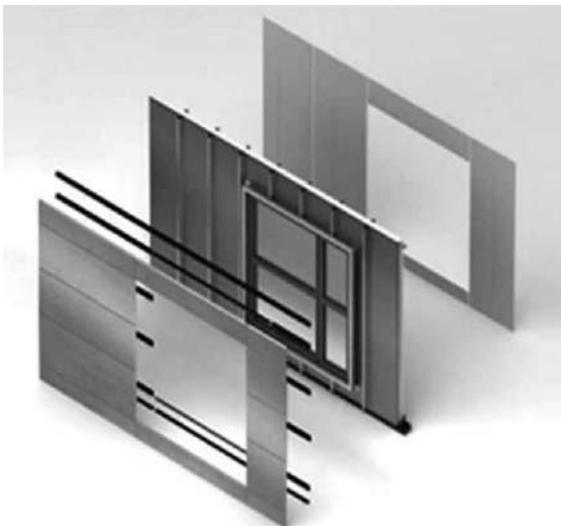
Paramento externo, painel metálico isolante e paramento interno de um sistema de vedação de fachada (BENCHMARK KINGSPAN, 2014)
